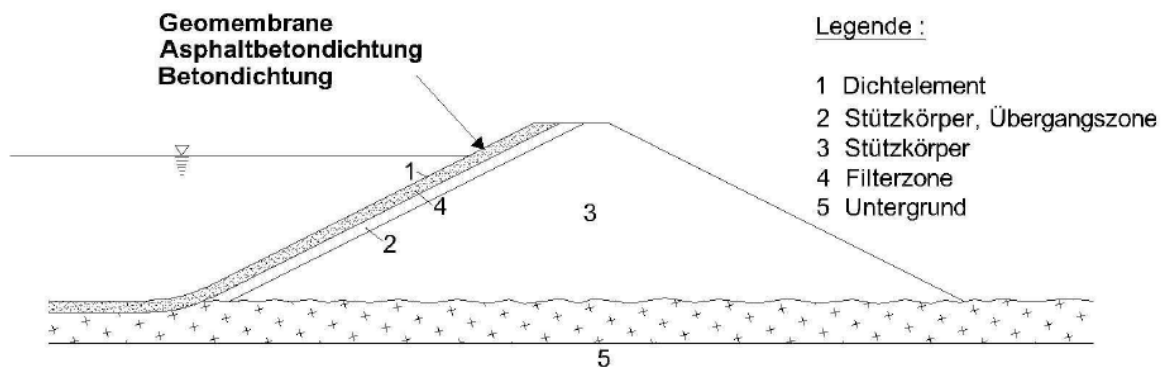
Damm mit Asphaltbetondichtung<sup>162</sup>
